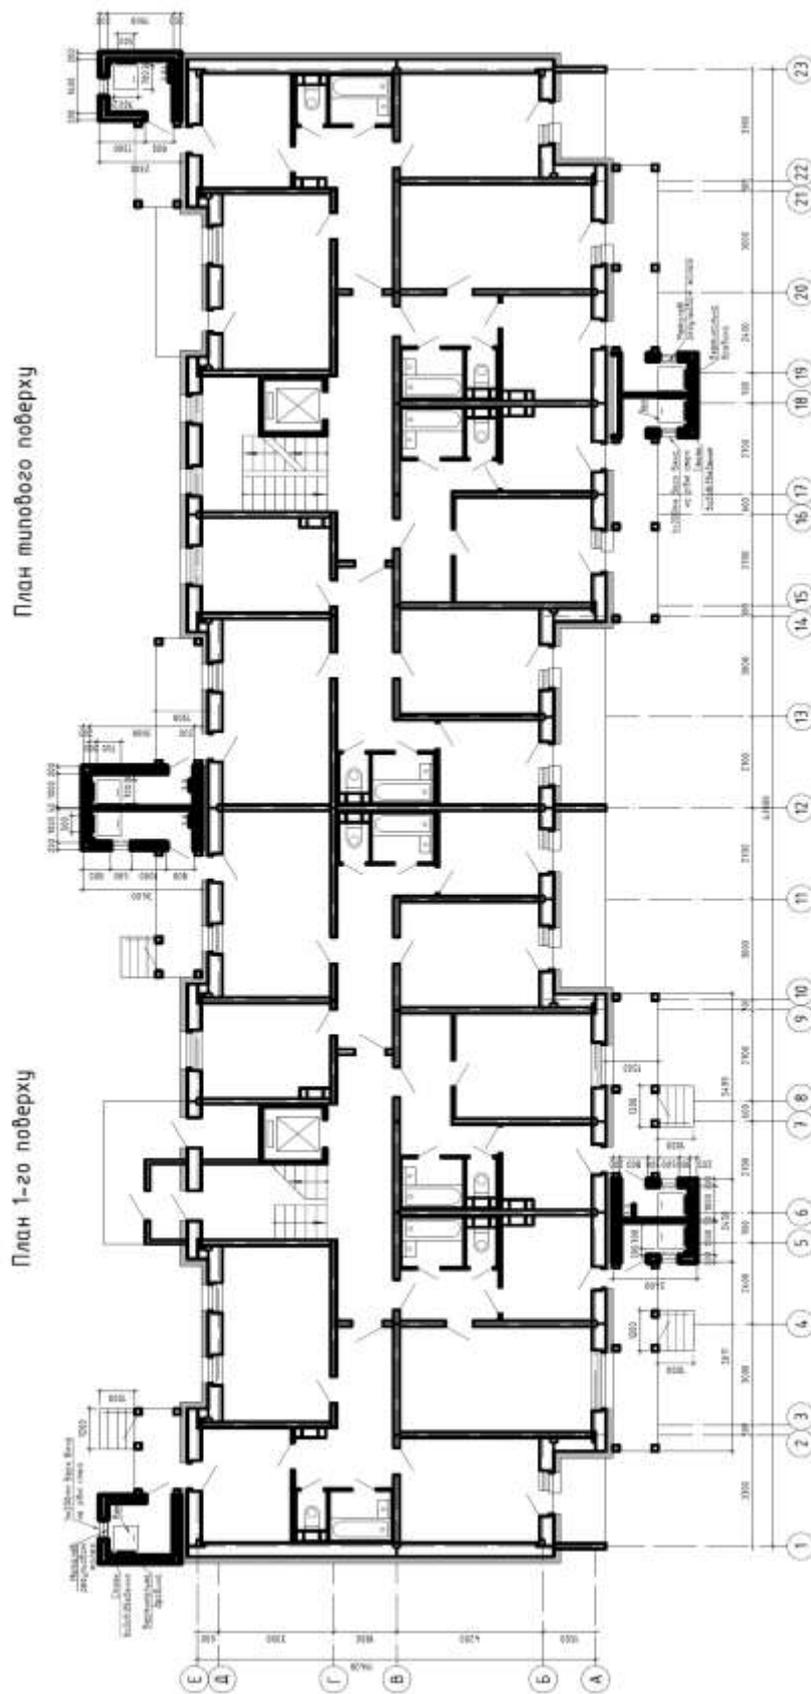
Варіант реконструкції панельної багатоповерхової будівлі з прибудовою захищених приміщень та окремо розташованих конструкцій балконів (плани першого та типового поверхів)
